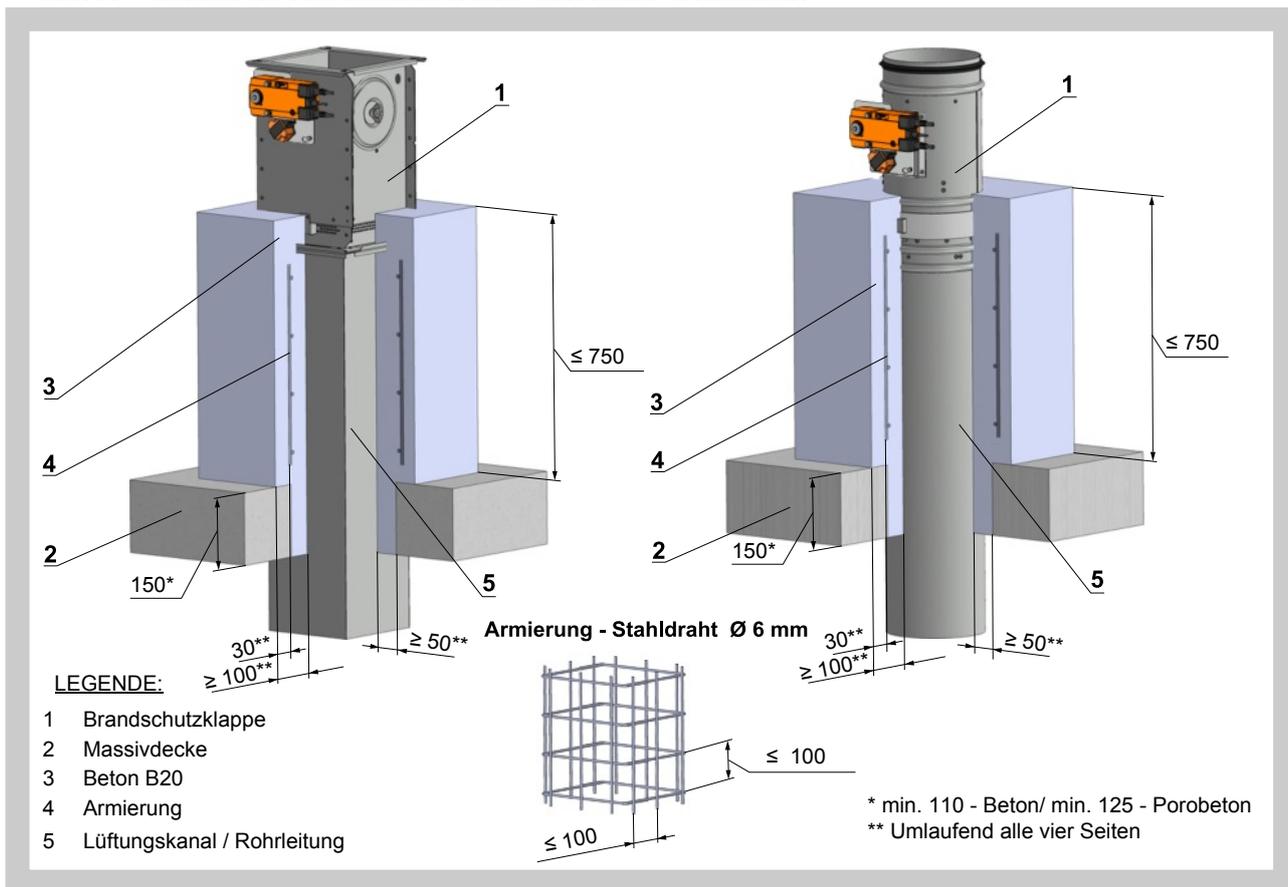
Entfernt von oder an Massivdecken - Nasseinbau - Betonmantel und Einbaurahmen E4, R5
